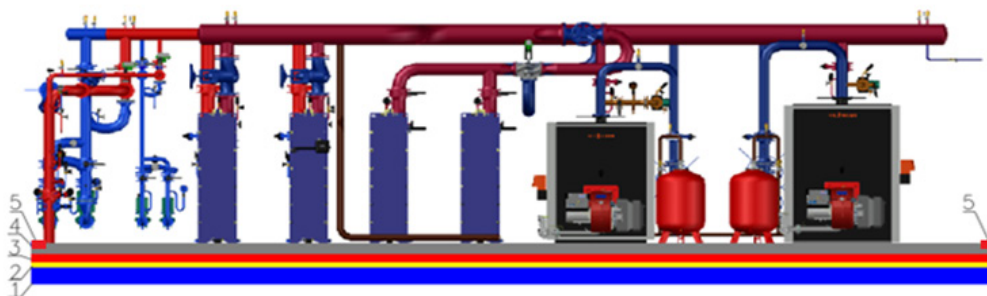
Схема установки инженерного оборудования крышной котельной на плите покрытия здания (с одним контуром упругого звукоизоляционного слоя):
